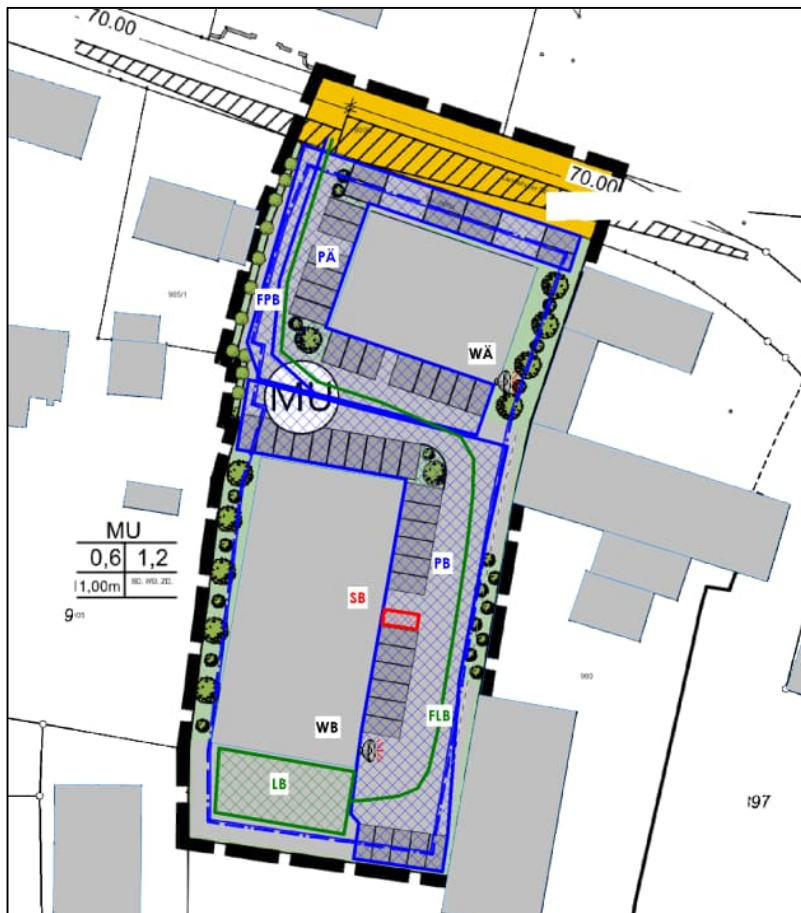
Lageplan mit Darstellung der relevanten Schallquellen
